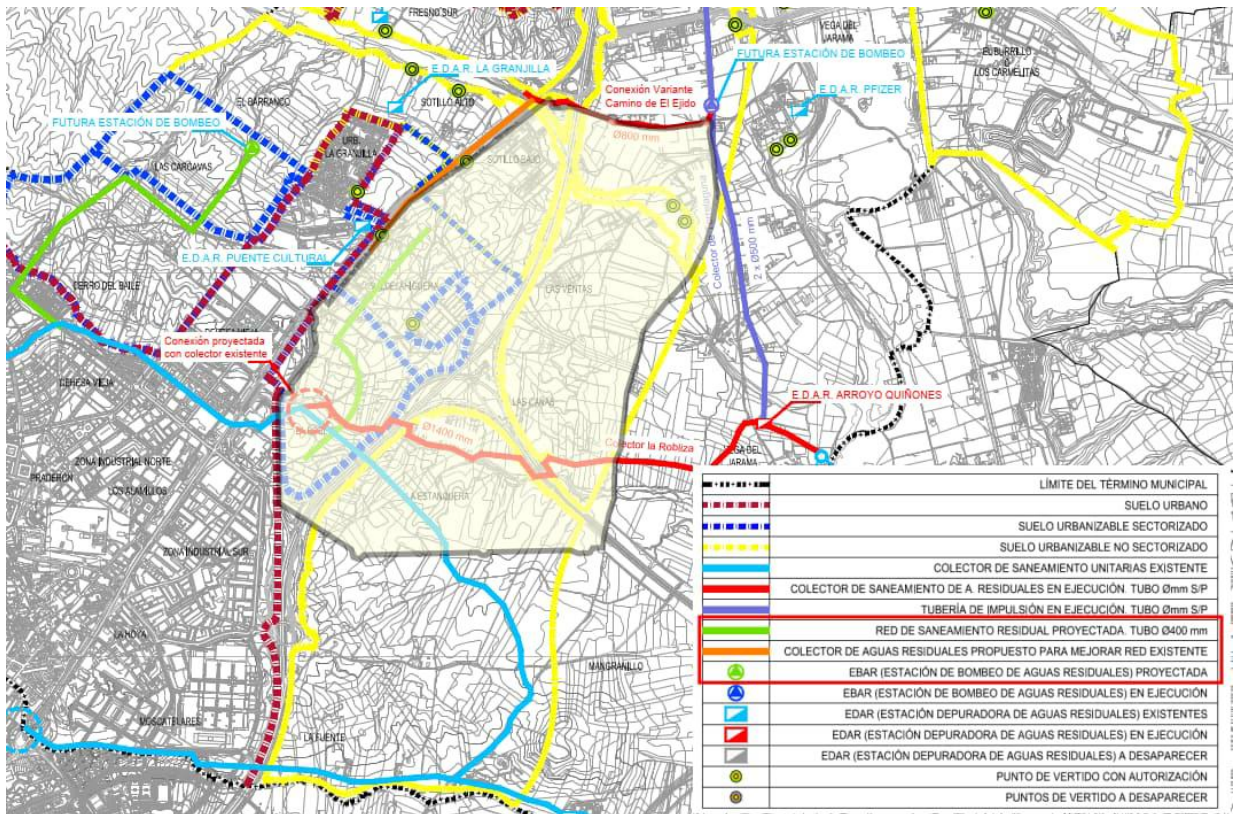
Infraestructuras de Saneamiento Residual Propuesto.
